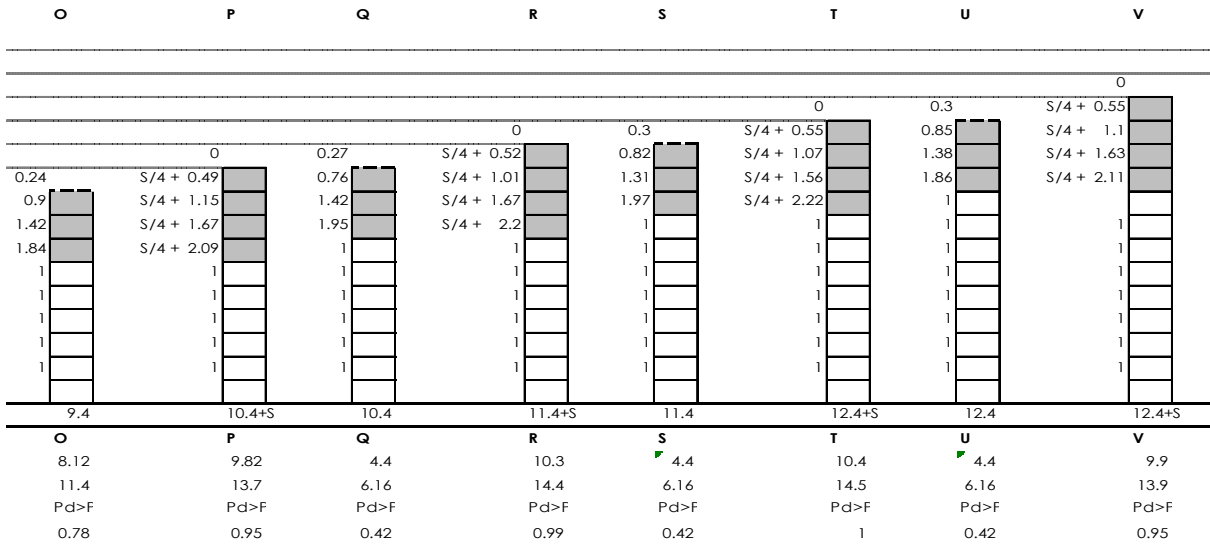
Proceso Constructivo. 4 Cimbras forjados de Losa Reticular. 3/4
